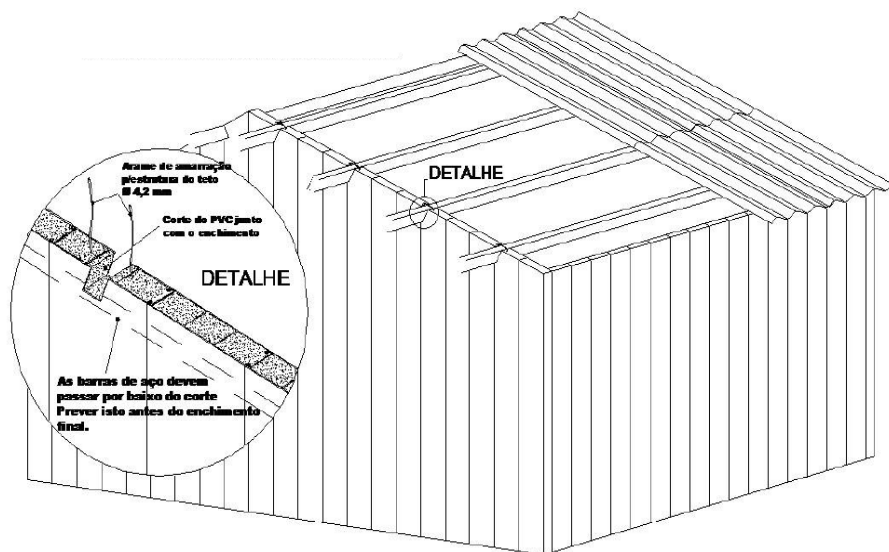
Tesoura de madeira apoiada nas paredes de concreto-PVC
